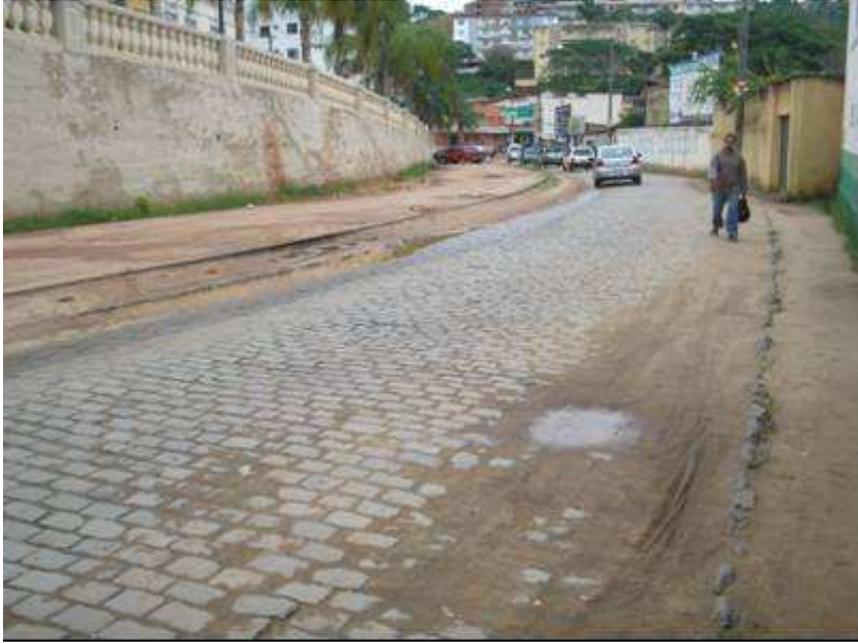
Ausência de pavimentação na calçada e pavimentação precária na Rua Benedito Valadares
